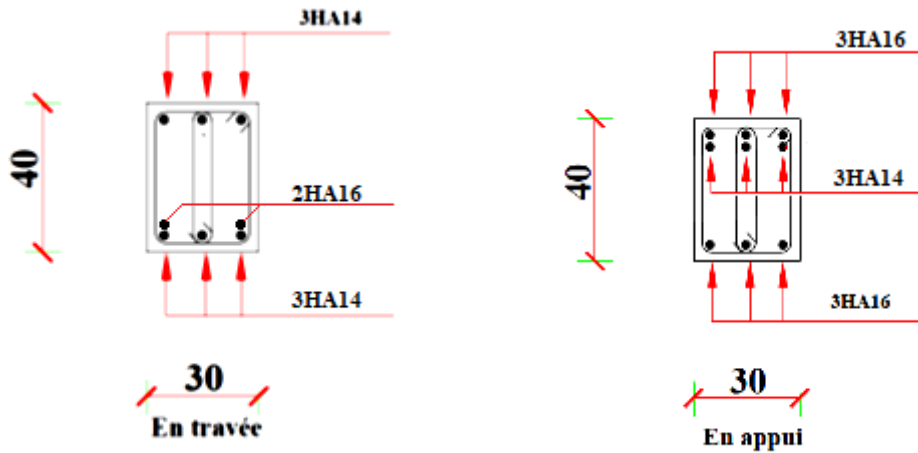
Croquis du ferrailage de la poutre secondaire
